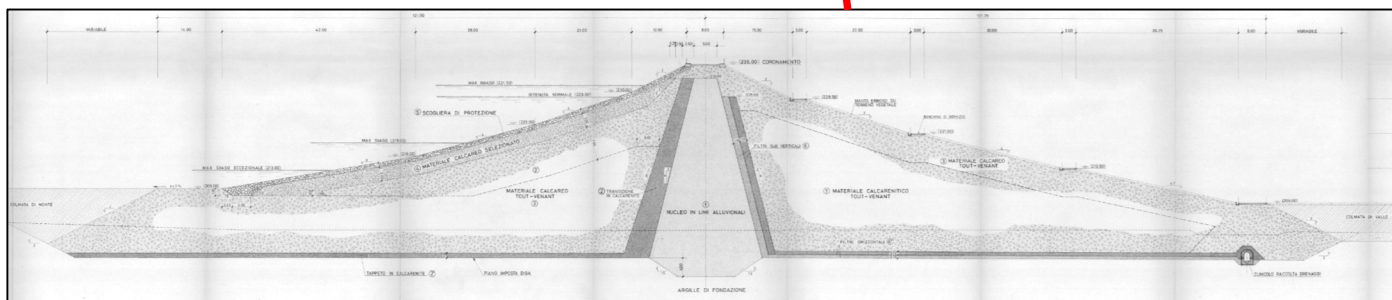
Diga di Gibbesi – Vista in sezione del corpo diga
